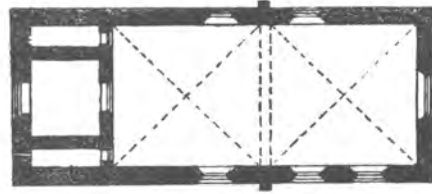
Gramzow; Kirche, Grundriss.
